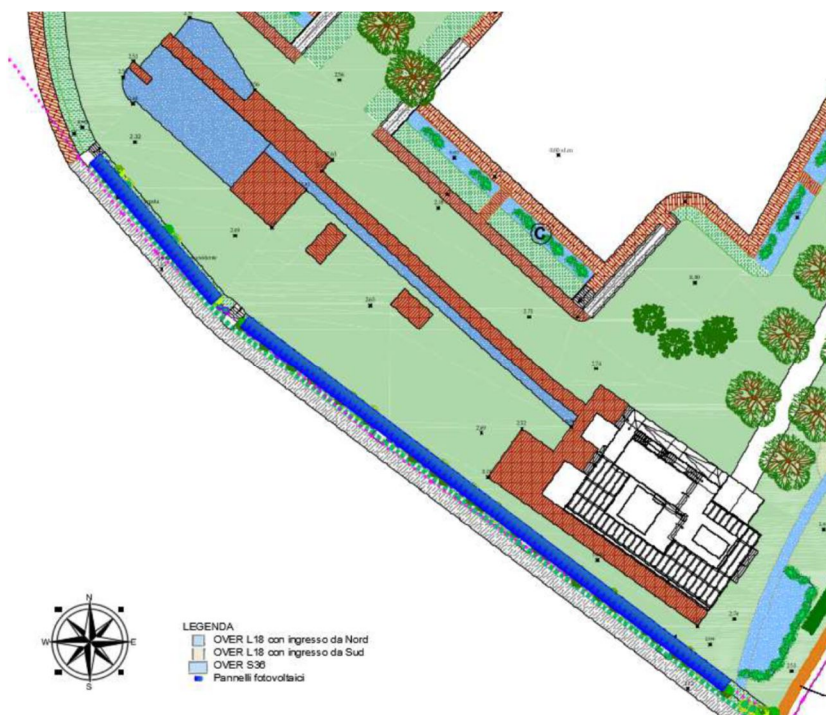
Planimetria di dettaglio impianto sponda lato-fiume, avente potenza pari a 64,86 kWp
